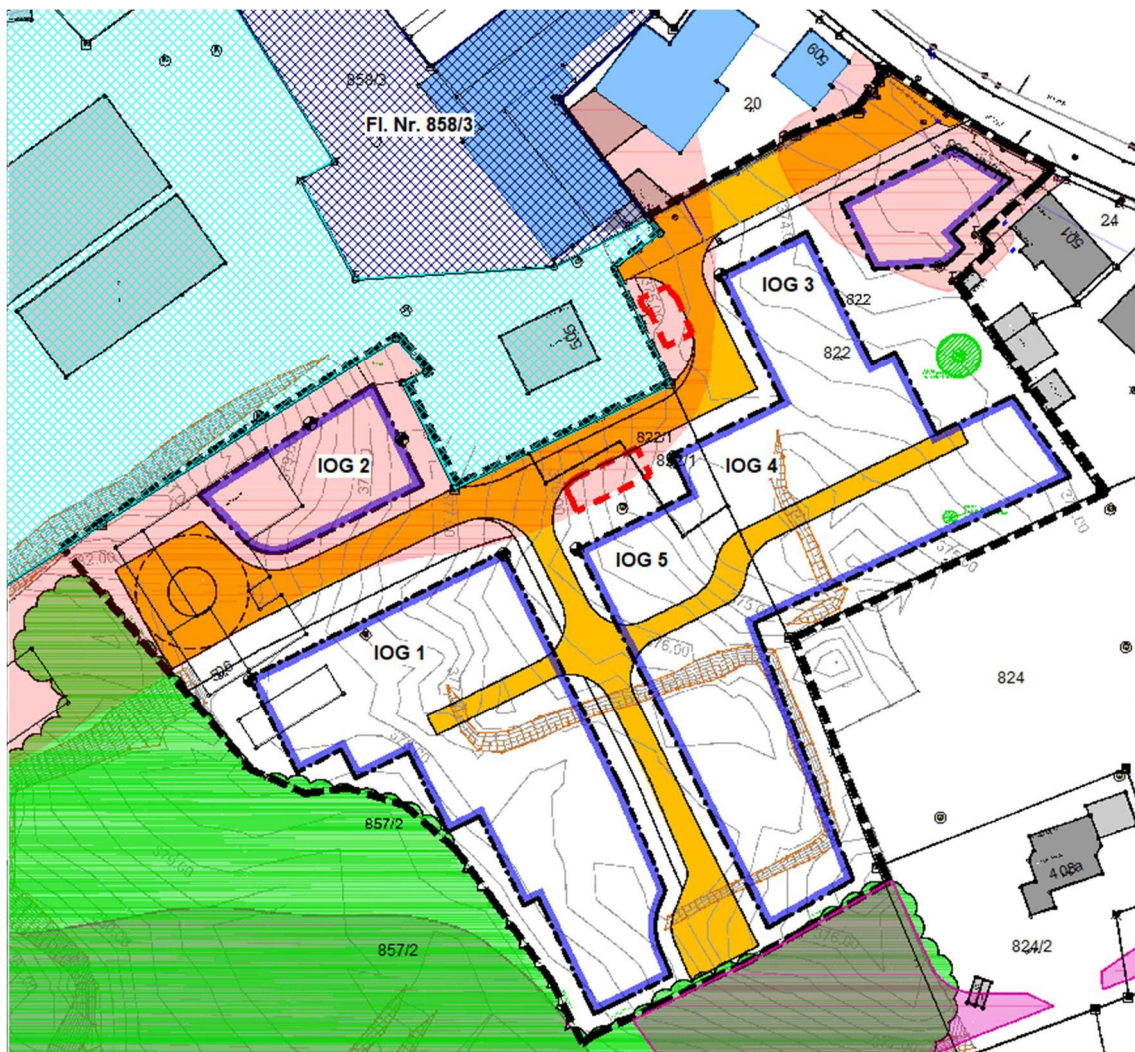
Lageplan mit Kennzeichnung der Immissionsorte Gewerbelärm IOG 1 – IOG 5
